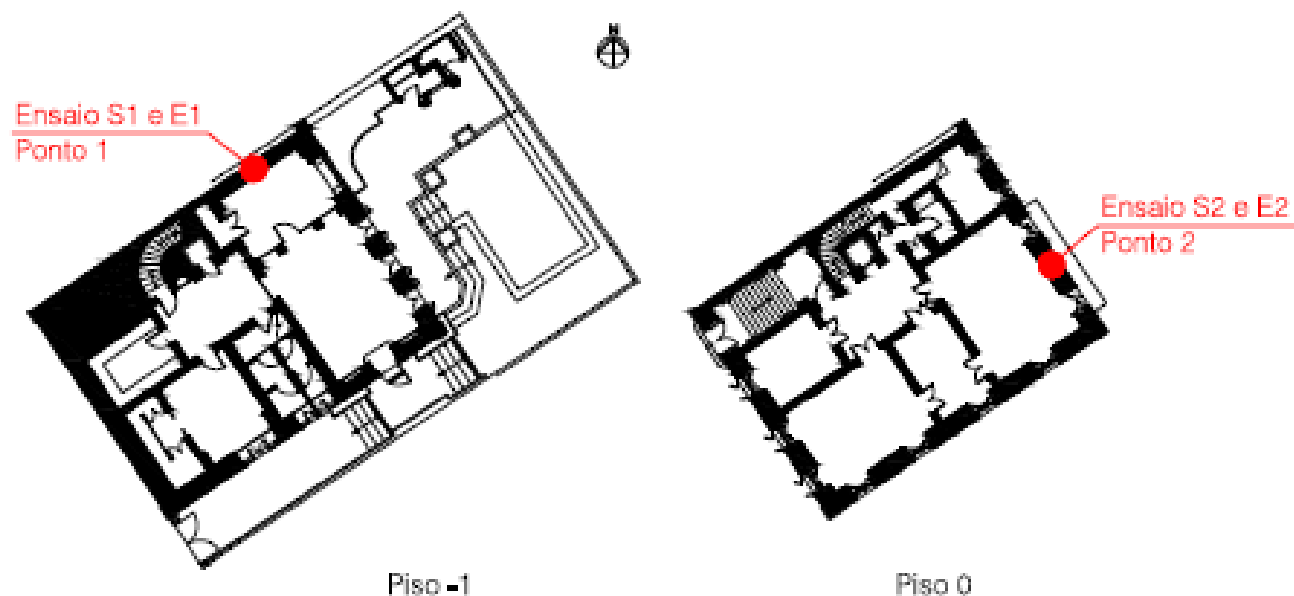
Pontos de ensaio sobre as plantas do edifício.
